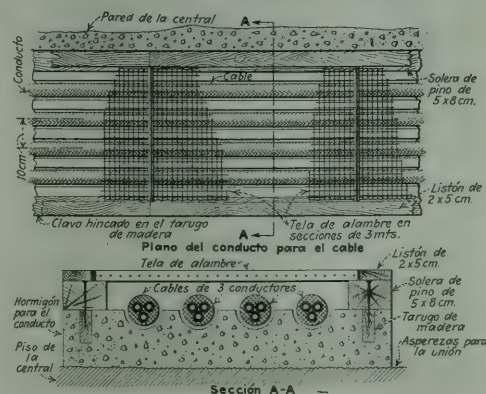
PLANO Y SECCIÓN DEL NUEVO CONDUCTO
